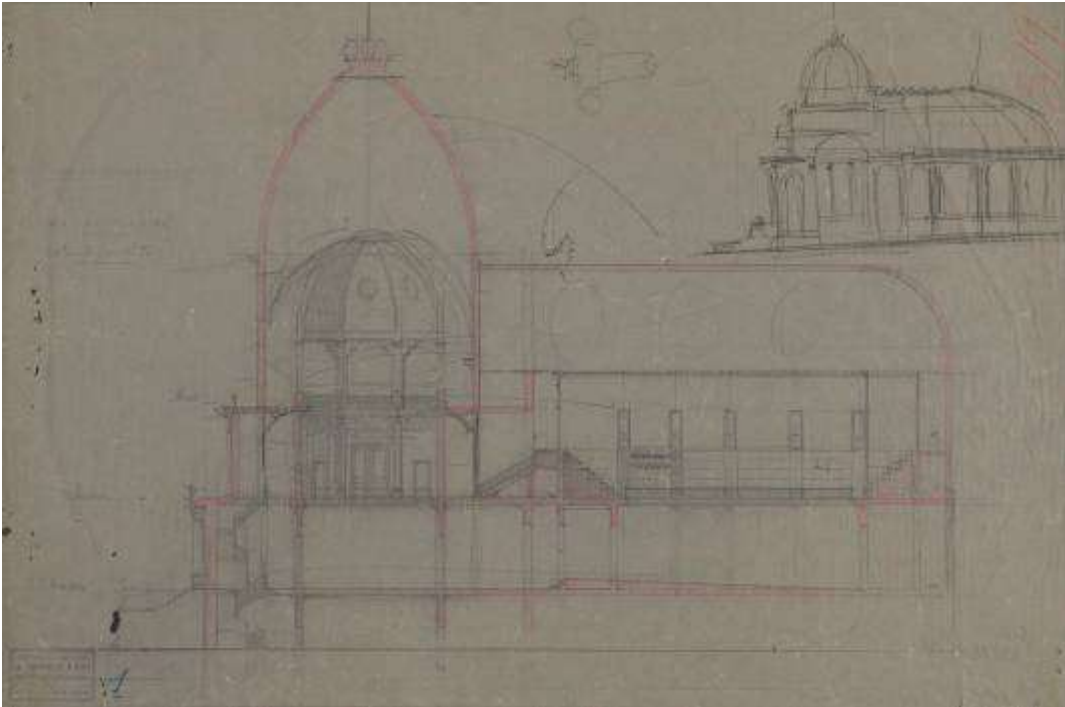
Proposta de construção de um anexo para abrigar a plenária (Fonte: Arquivo Nacional).
